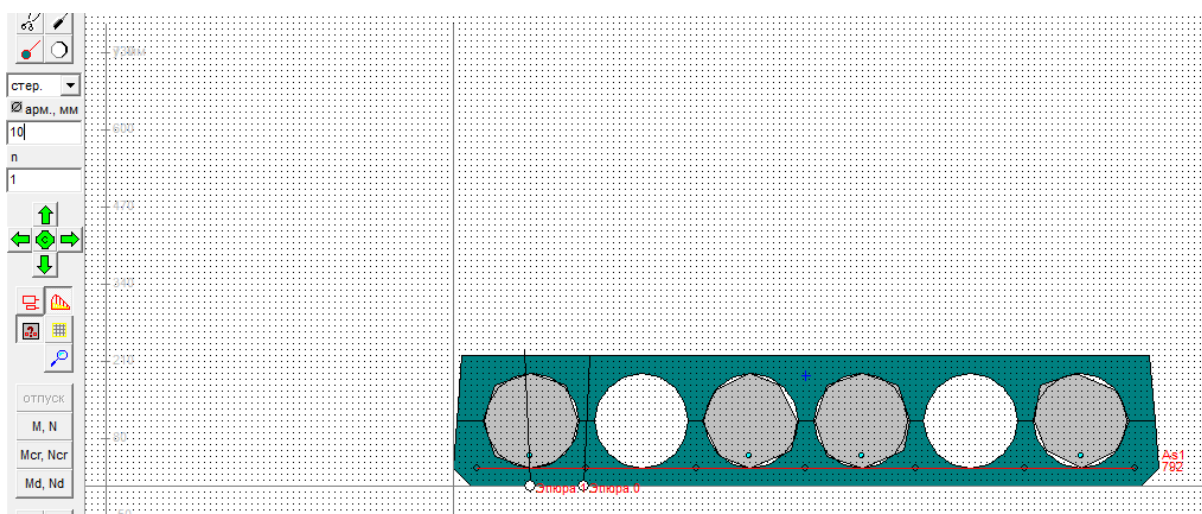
Скриншот программного комплекса с данными по стеклопластиковой арматуре, используемой для усиления многопустотных плит
